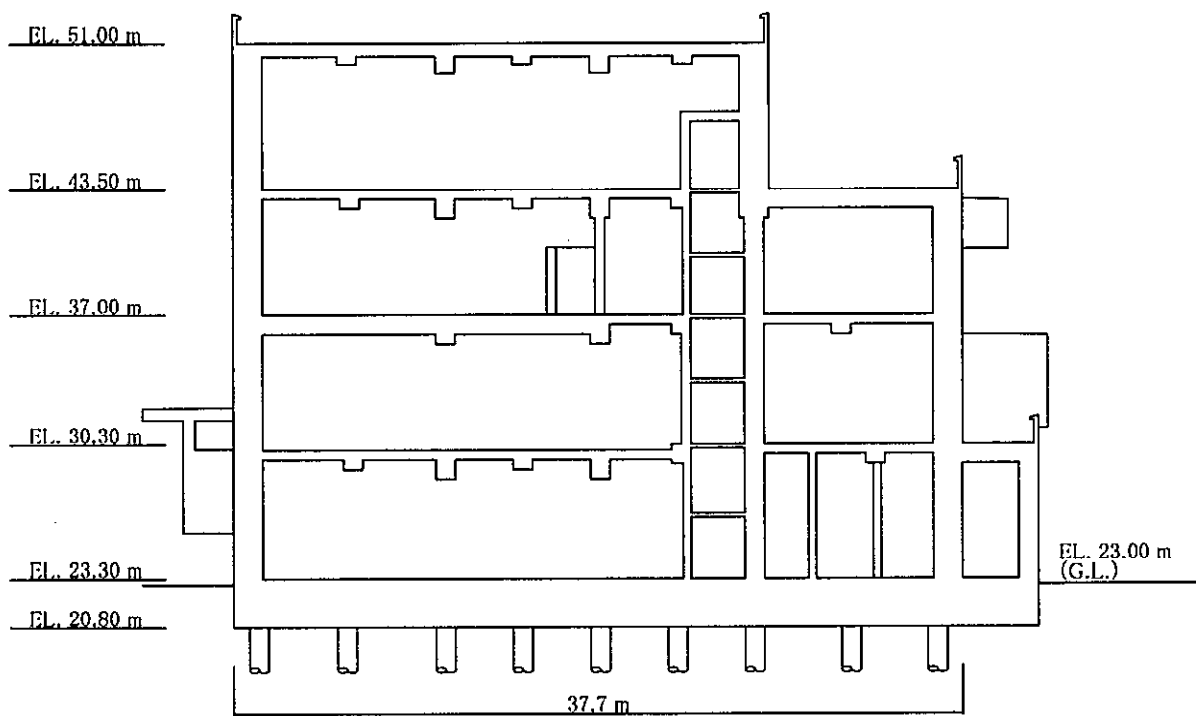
(1/2) 緊急時対策所建屋の概略断面図 (A-A 断面)
